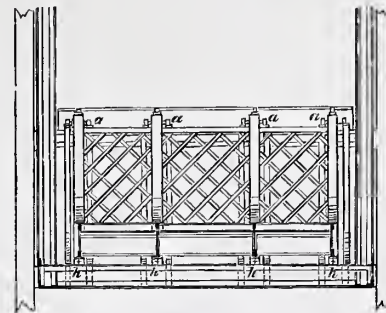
Schnitt nach A-A durch das Fördergerüst und Drehgestell.
